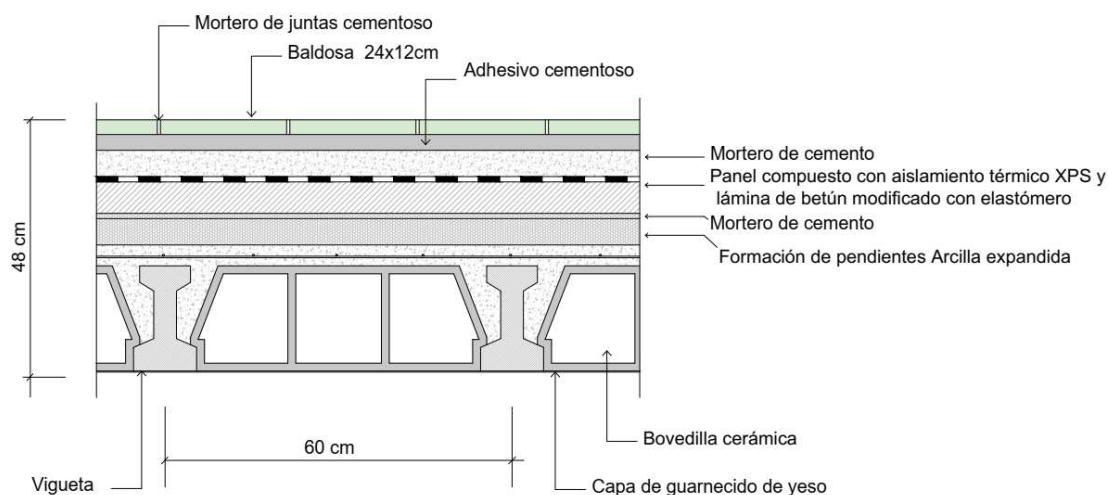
Detalle sección cubierta plana transitable. Fuente propia programa AutoCAD
